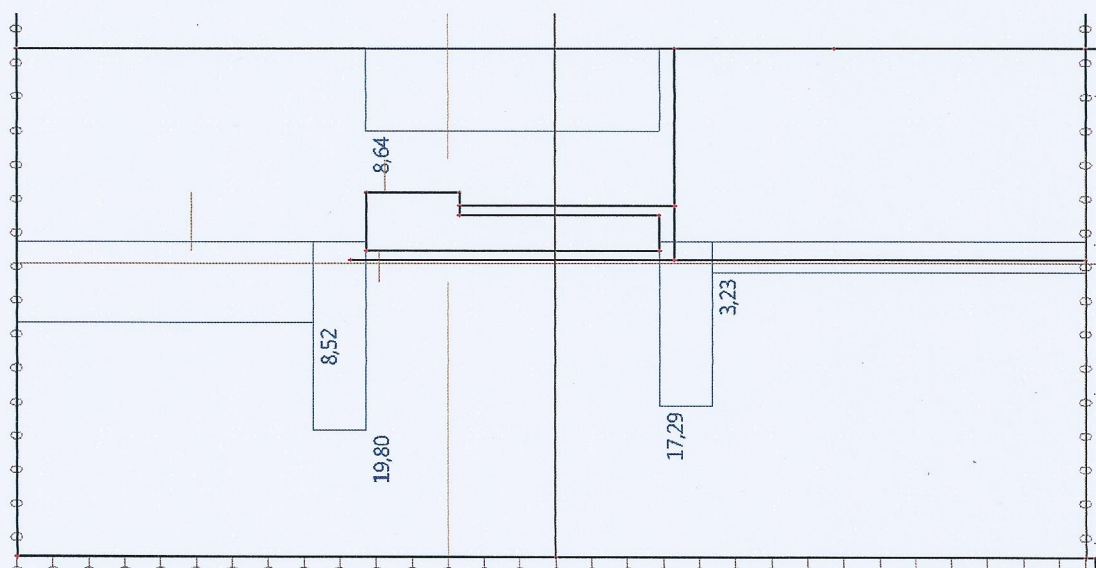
Hodnoty mxD - pro dimenzování dle jednotlivých pásů v části s otvorem
